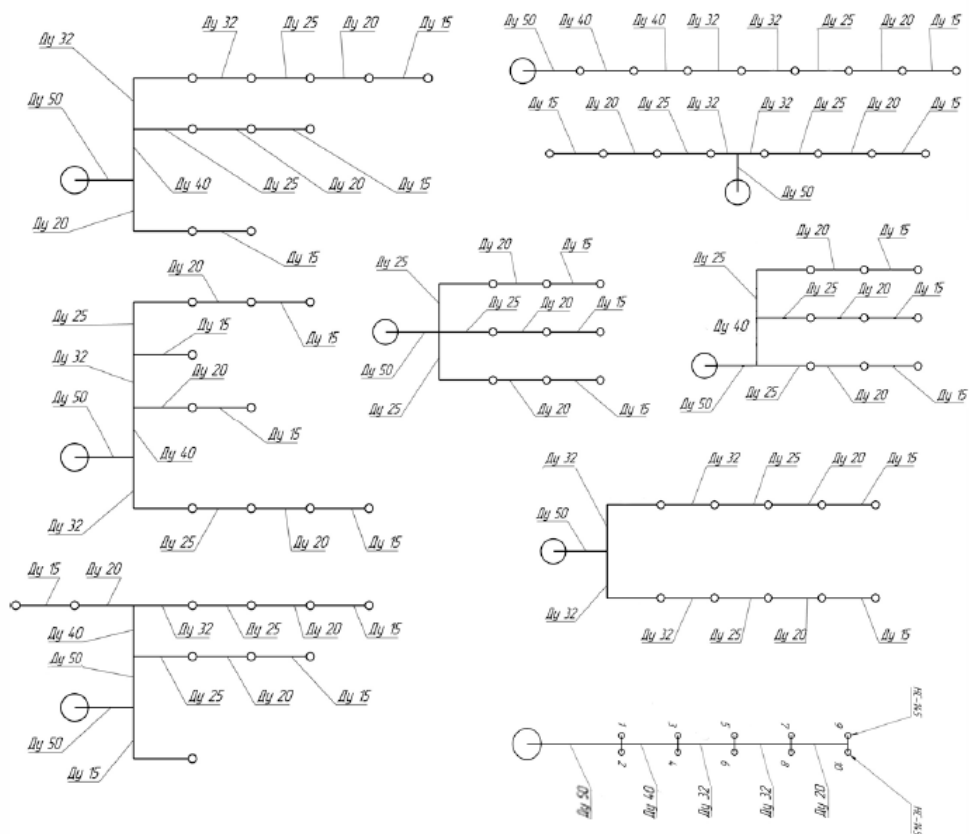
Примеры схем проектирования трубопровода в составе МУПТВ-160-Г-ВД с насадками-распылителями «НС-145».
